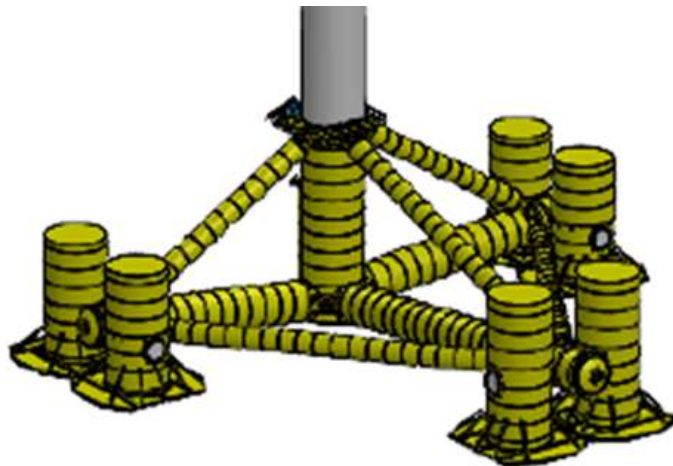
Alternativa fondazione galleggiante presentata con il progetto definitivo (TetraSub)
